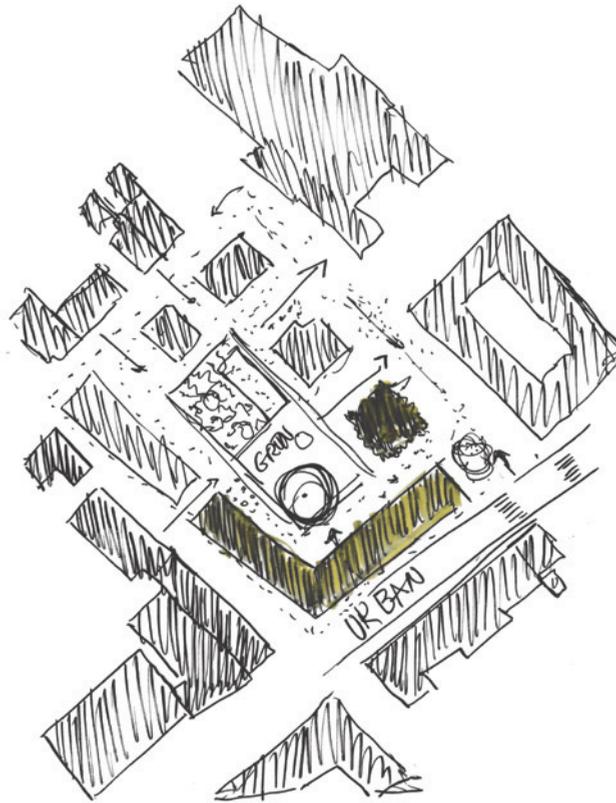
Konzeptskizze vom Lageplan und Öffnungen in der Erdgeschosszone zum Quartiersplatz
